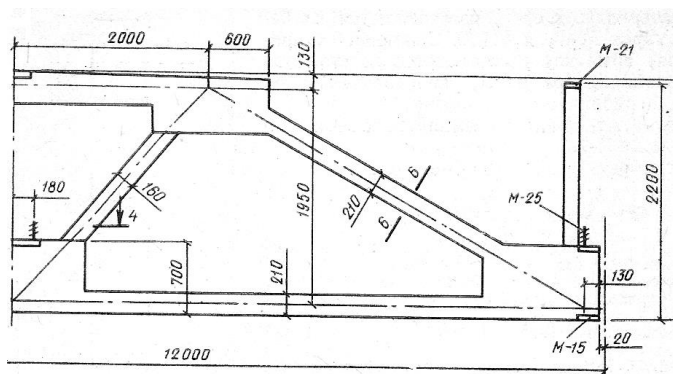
Подстропильная железобетонная ферма для скатных покрытий
